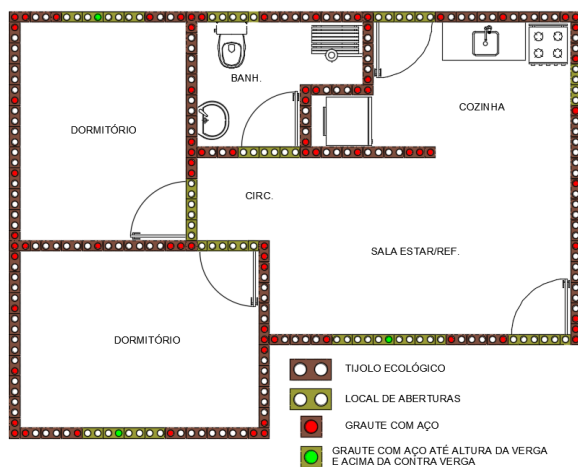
Planta baixa do projeto com tijolo ecológico. Fonte: autoria própria.
